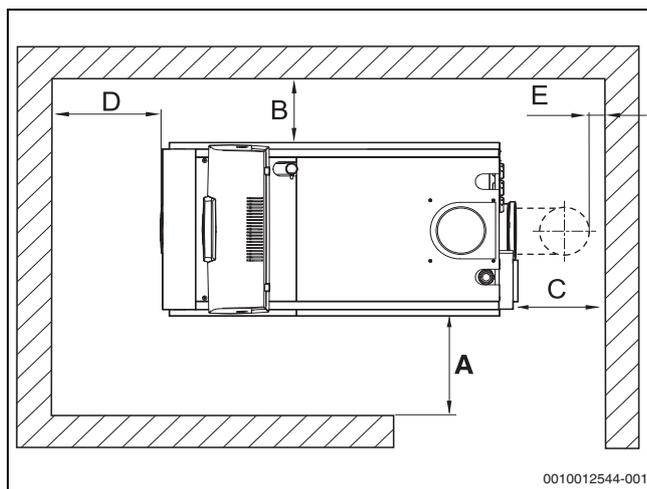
Distanze dalle pareti nel locale di posa (versione destra)
